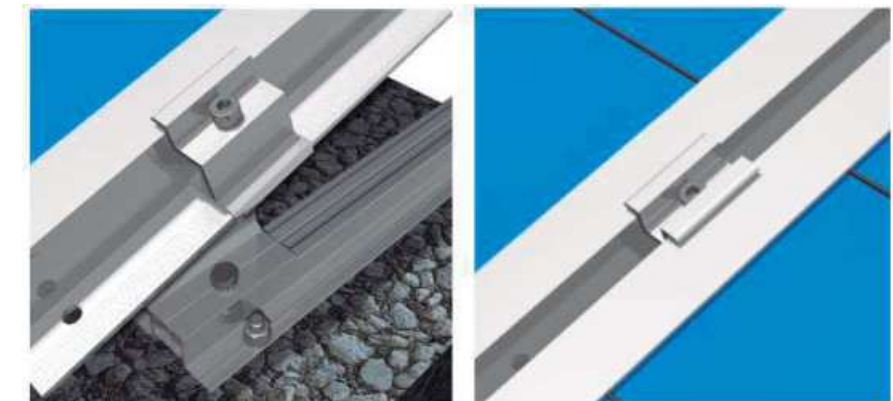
Detalle Brida Extremo y brida intermedia para la fijación de las placas fotovoltaicas
